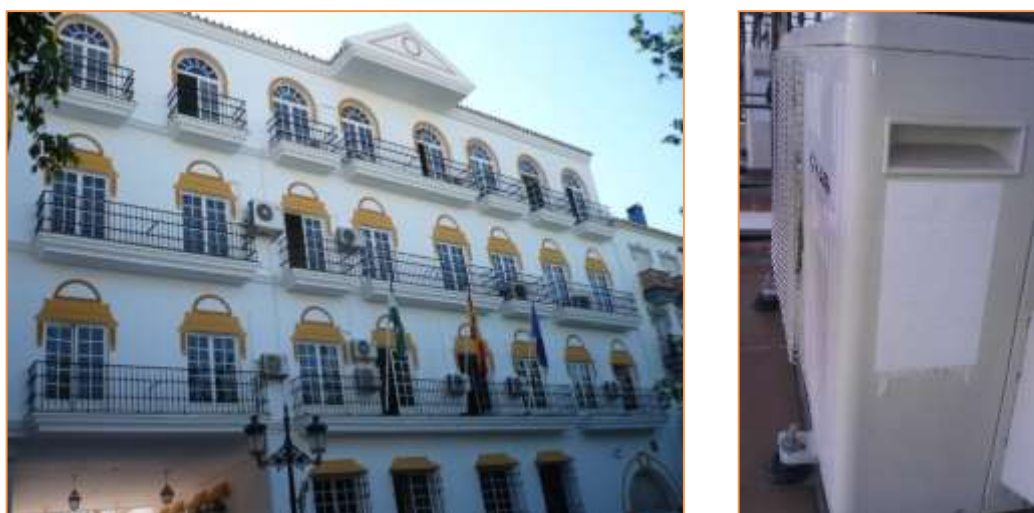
Equipos de producción de frío y calor para climatización. Split 30,31 y 35 - 39 Fachada Oeste – Tercera planta
